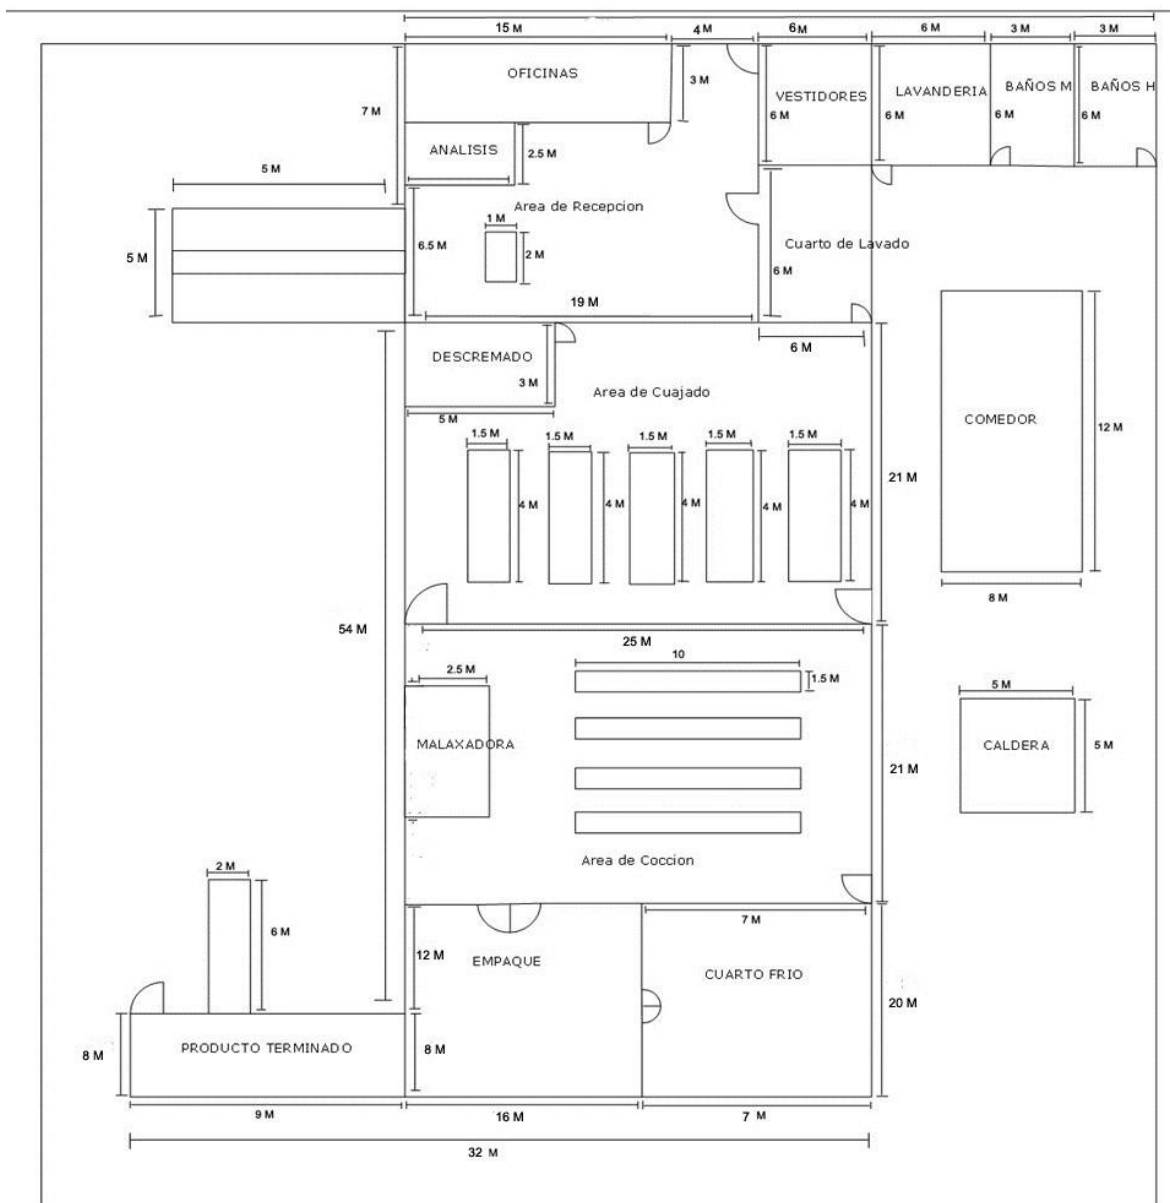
Propuesta de la distribución de la planta “Las Mesas”
